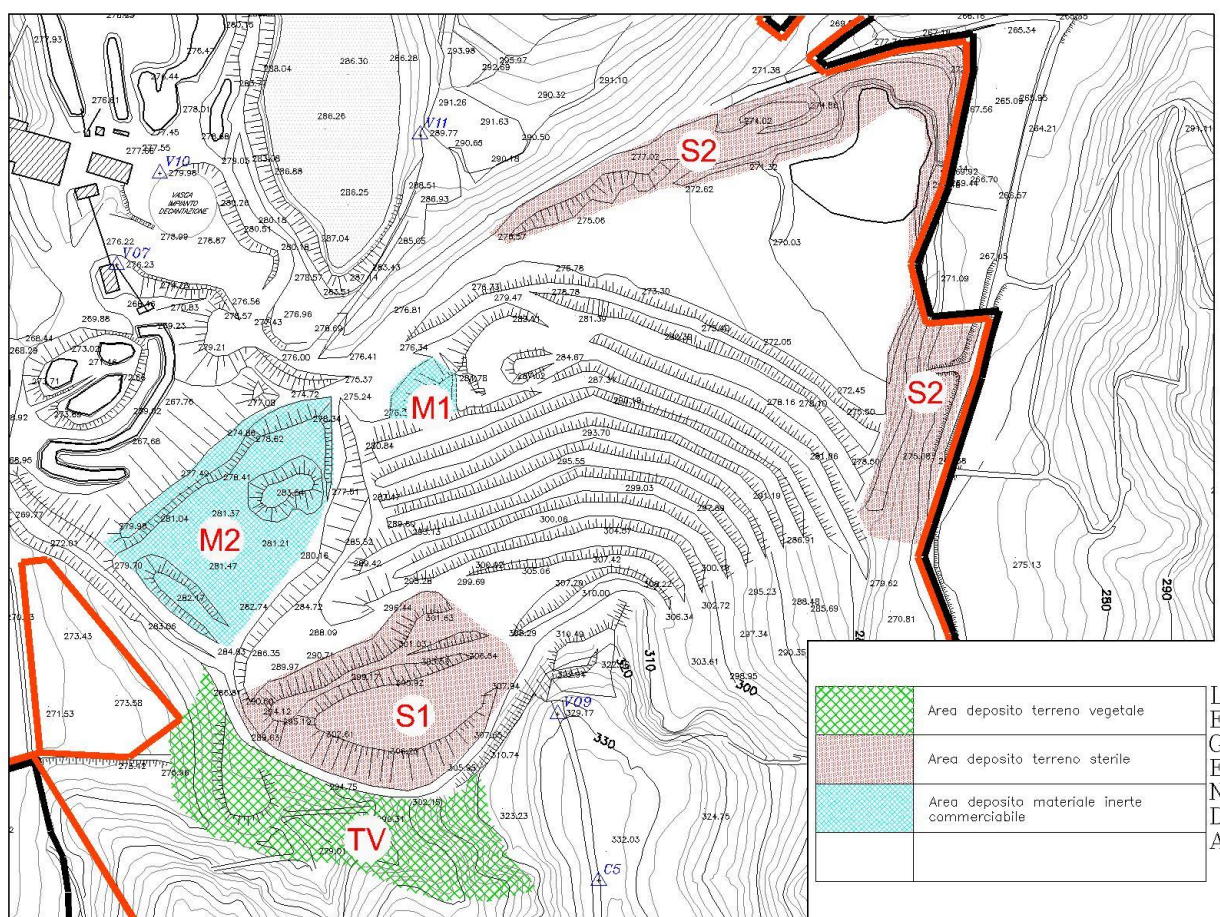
estratto planimetria con ubicazione dei depositi terreno vegetale e sterile.
